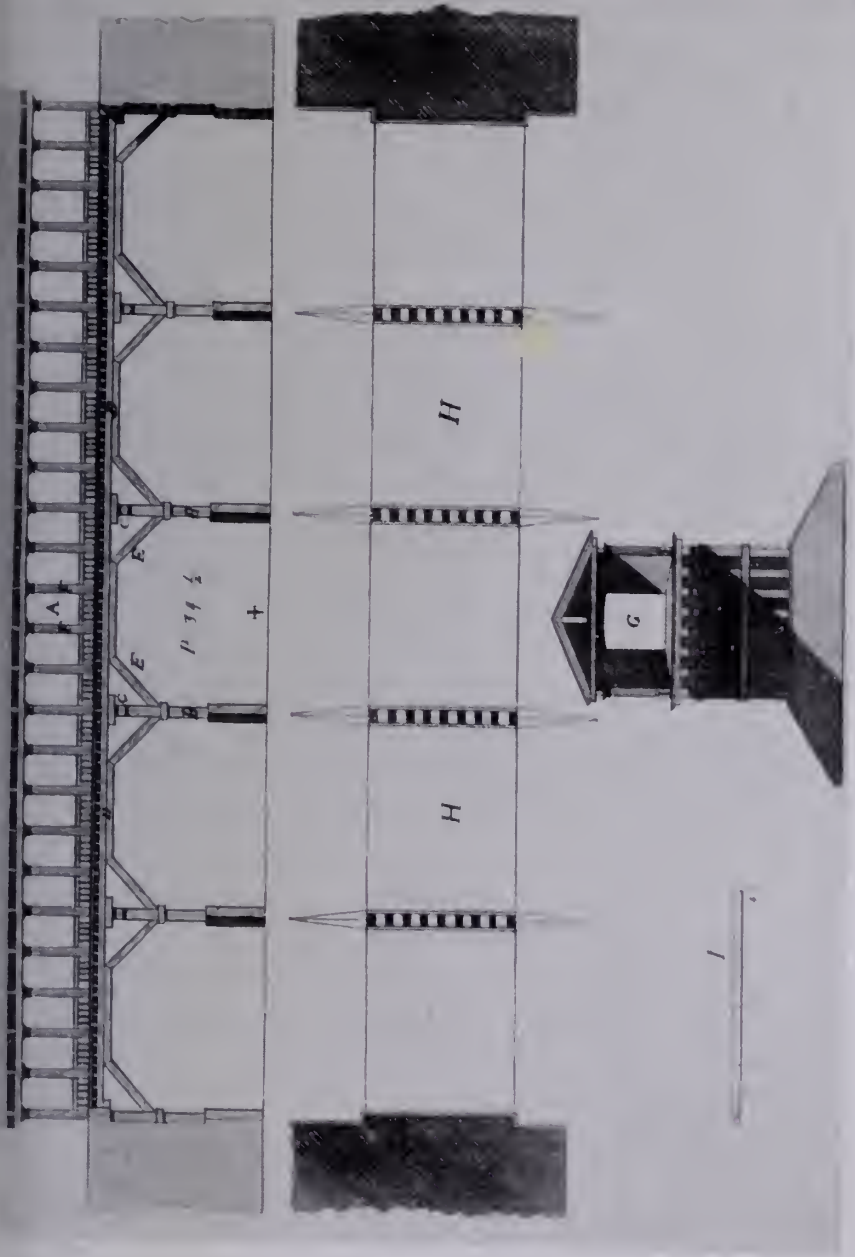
Bassano, Ponte di legno. Palladio: Prospetto.
